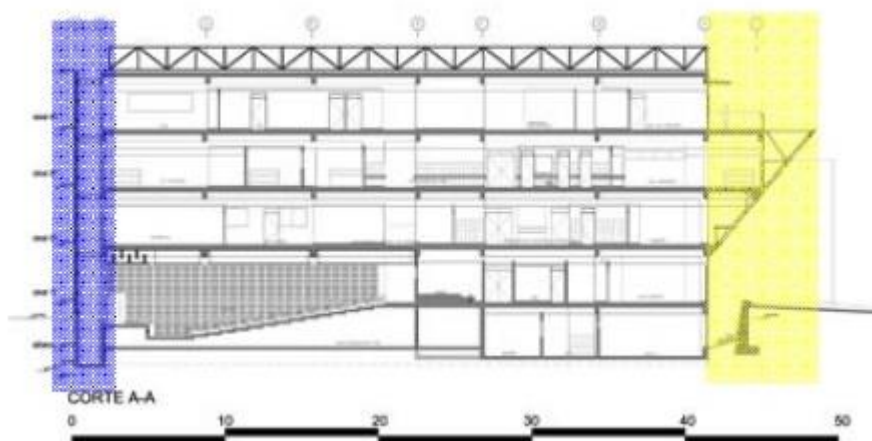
Fachada sur, ángulo de protección 60°y fachada norte 34°. Fuente: Arq. Javier Caravedo
